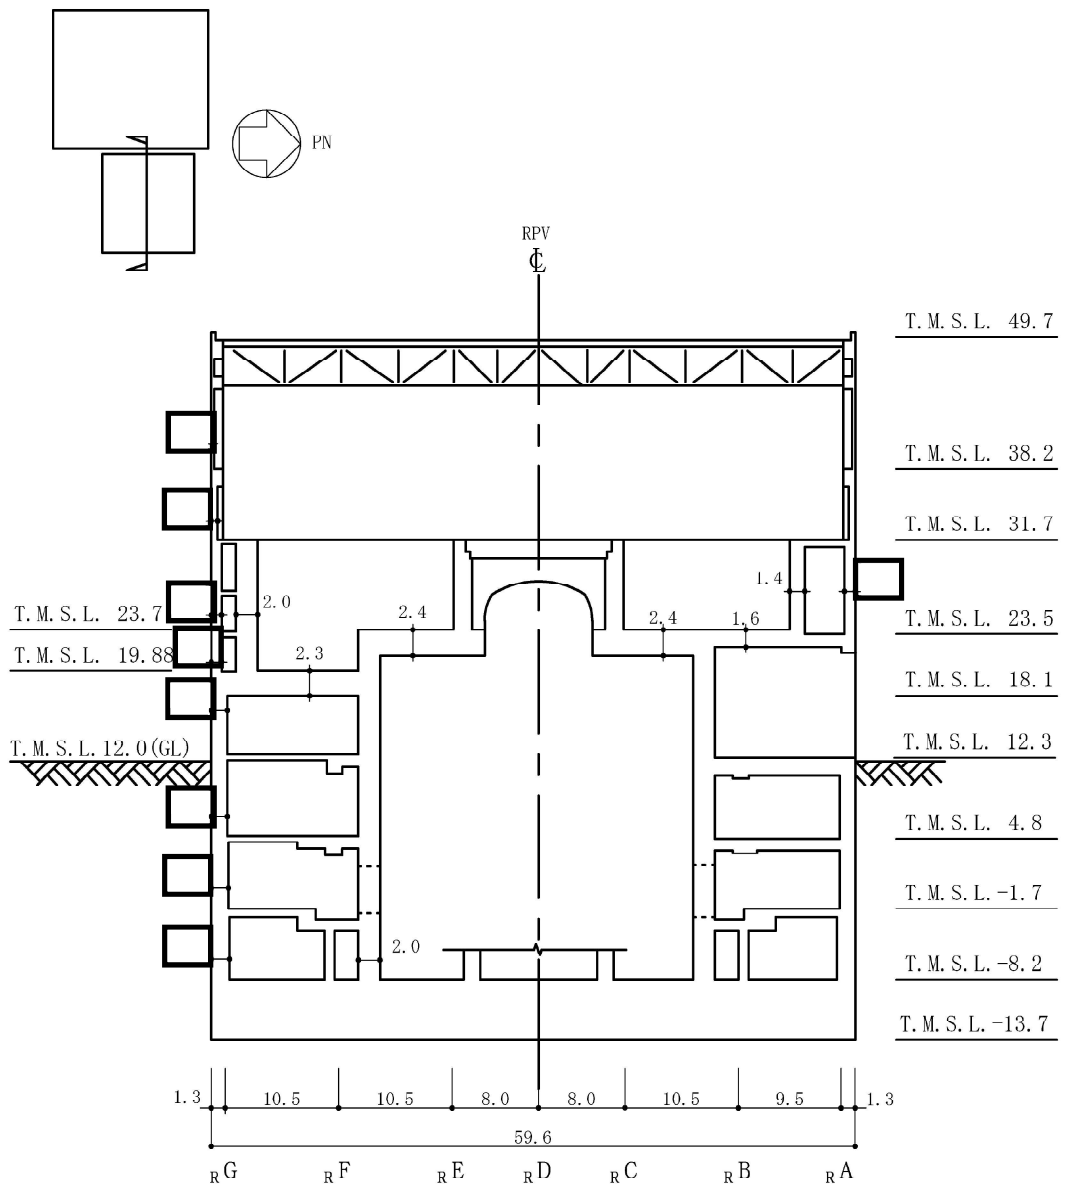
原子炉建屋の概略断面図 (EW方向) (2/2) (単位 : m)
